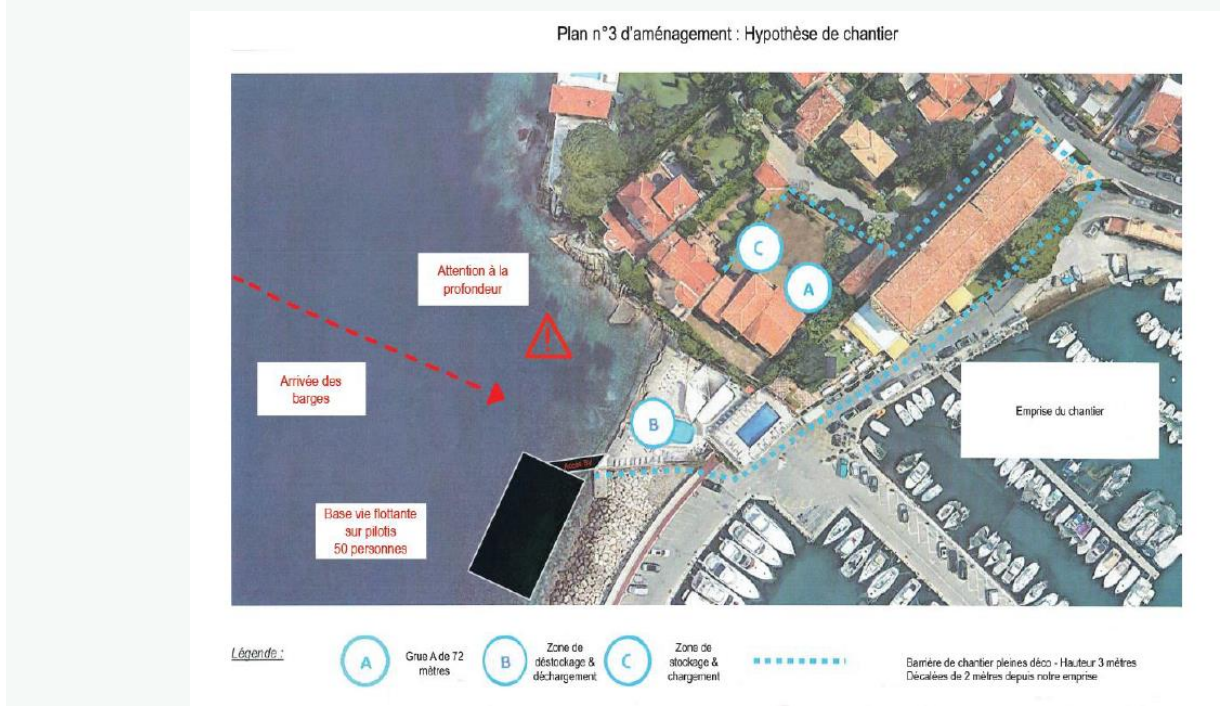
EXTRAIT DU PROJET DE RECONSTRUCTION LOT 03-INSTALLATION DE CHANTIER - ECHAFAUDAGE - MOYENS DE LEVAGE
